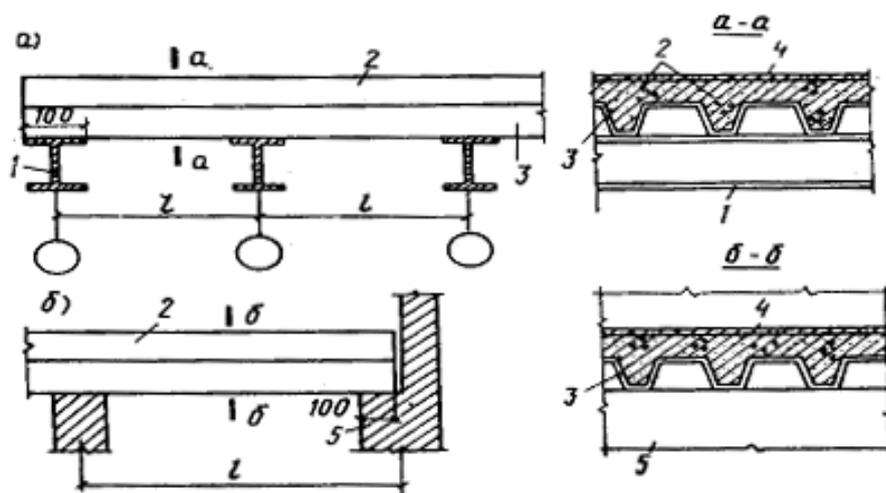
Конструктивные схемы монолитного перекрытия по СПН: 1 - прогон; 2 - плита из монолитного бетона; 3 - стальной профилированный настил; 4 - арматурная сетка; 5 - стена (кирпичная или бетонная)
